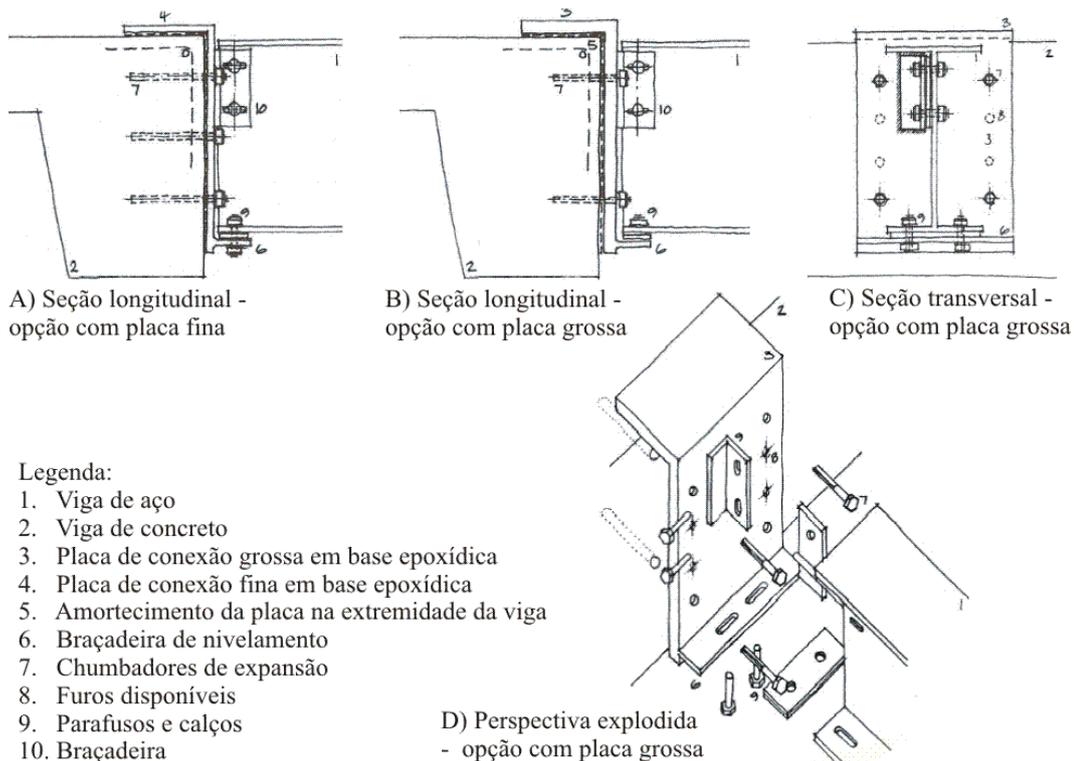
Viga de aço simplesmente apoiada em viga de concreto.
